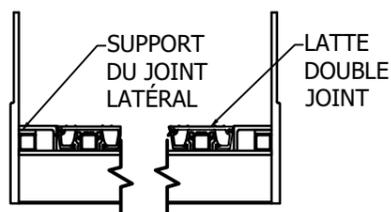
CORNIÈRE MÉTALLIQUE OU ALUMINIUM EXTRUDÉ JOINT LATÉRAL
